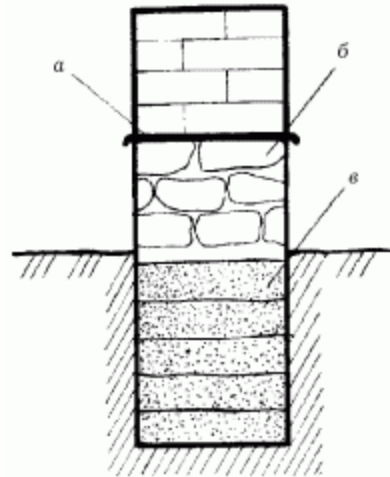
Устройство ленточного фундамента баню: а – слой рубероида; б – цоколь из бута на растворе; в – утрамбованный песок или щебень.
